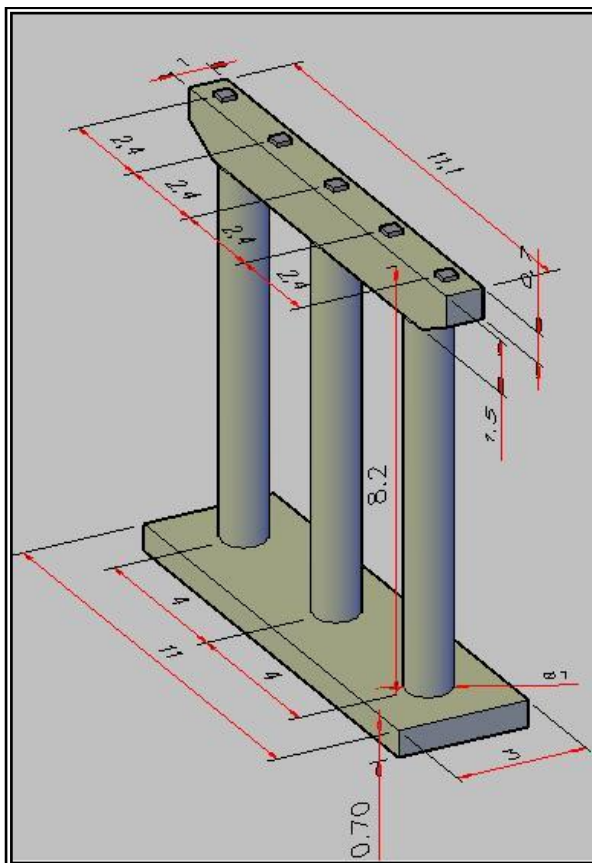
11 Geom etría de la pila (Sin escala).
